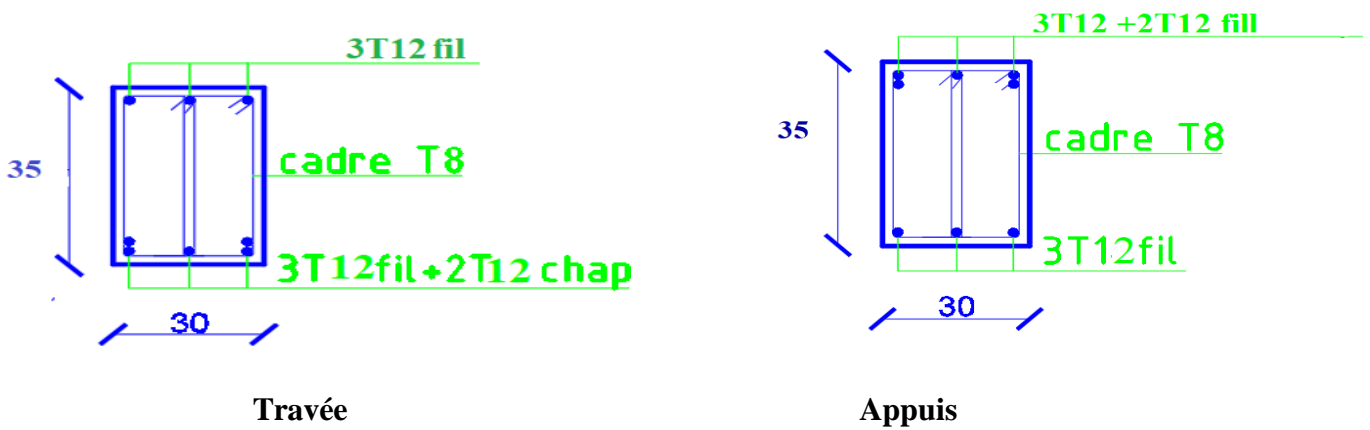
Schéma de Ferrailage de Poutre 35x30 cm .
